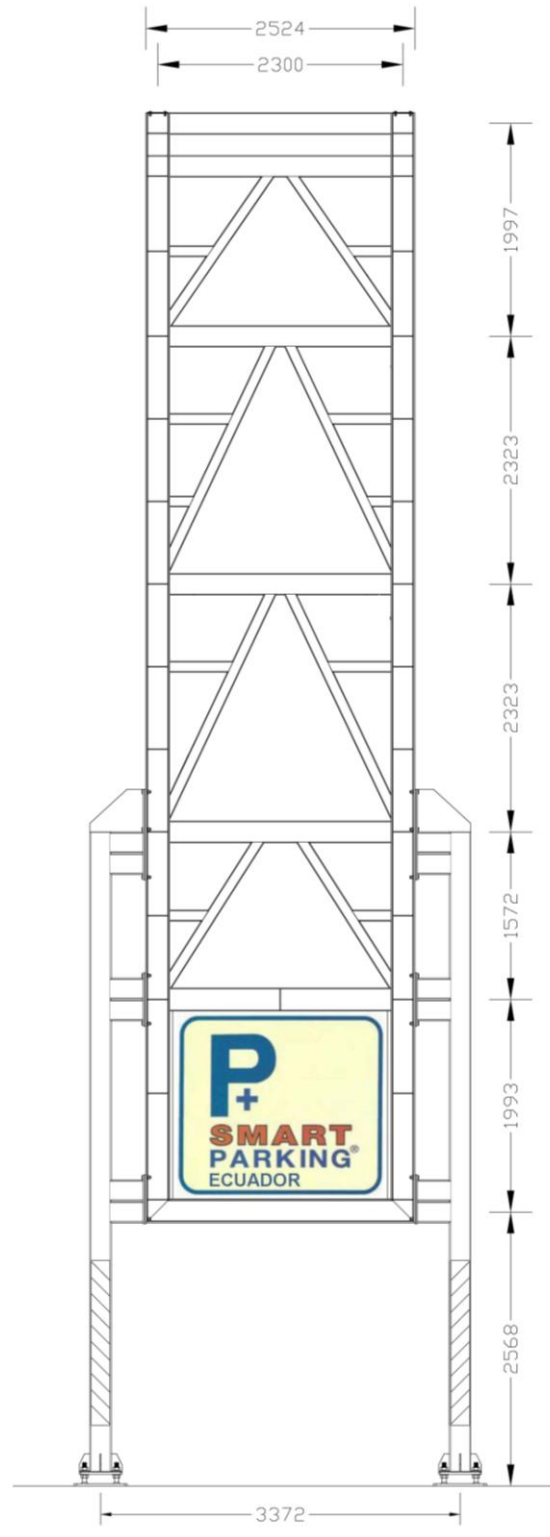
Esquema Estructural Columnas Tramo 1 y 2.
